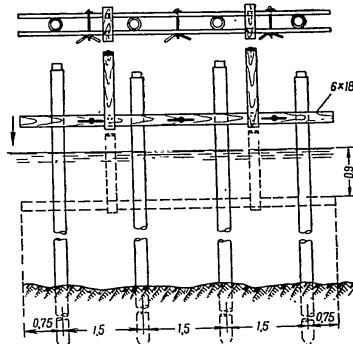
Горизонтальные скрепки для выравнивания, опиловки свай и укладки насадки.
